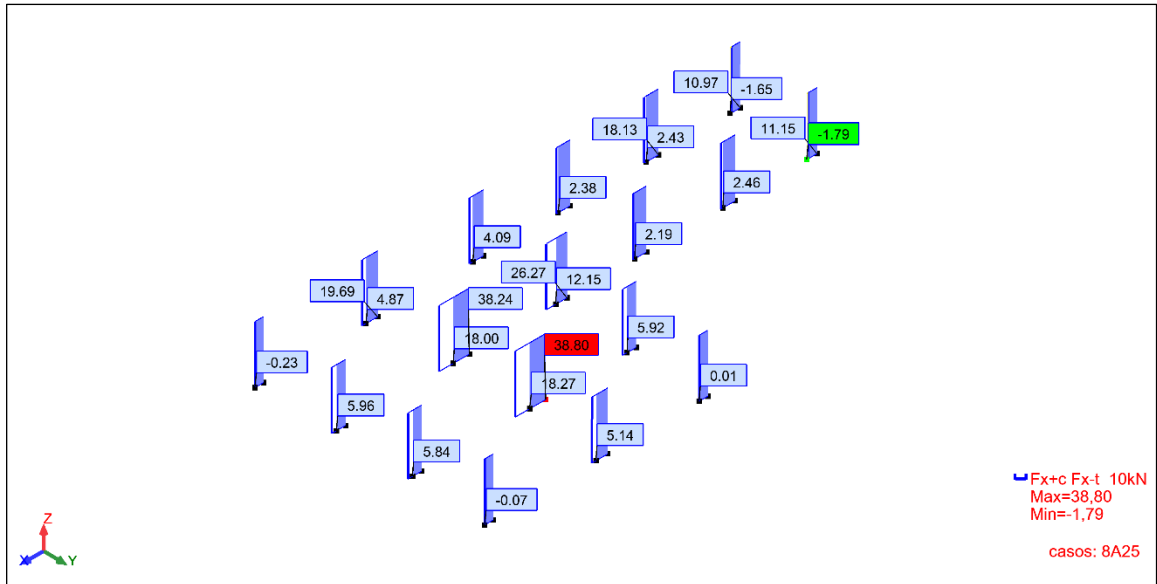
Cargas de cortante en dirección X, para columnas.
